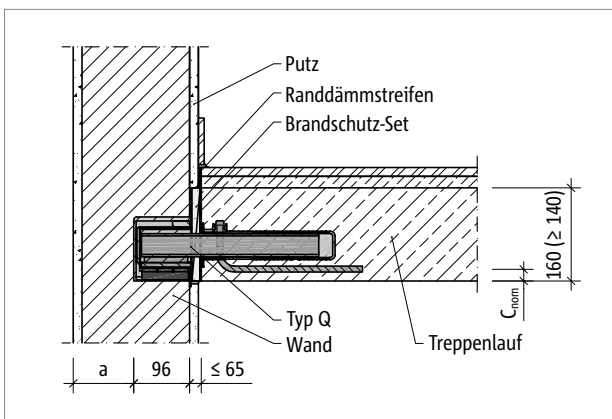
Schöck Tronsole® Typ Q: Brandschutzausführung
